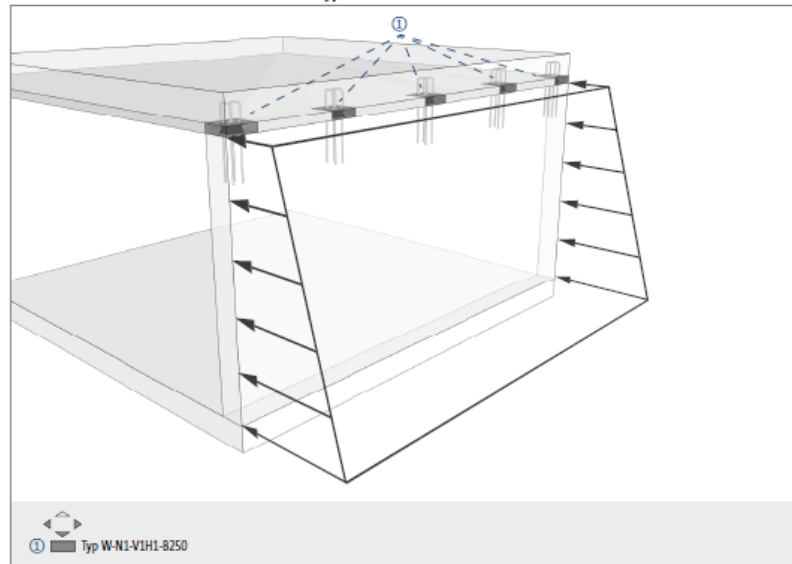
Erddruckbelastete Wand unter Decke getrennt
